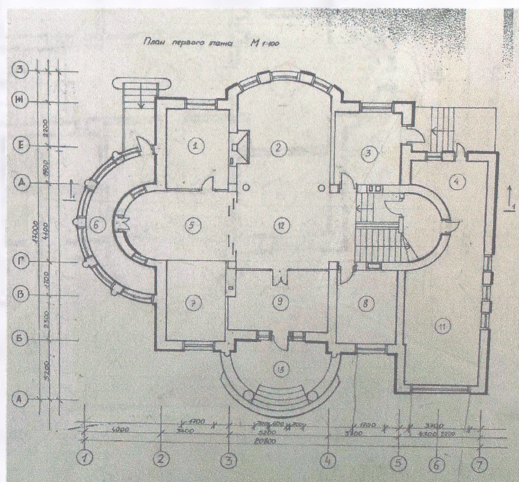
План жилого дома (фрагмент проекта студента гр. ДАС-3-14 Эсеновой Айканыш)
